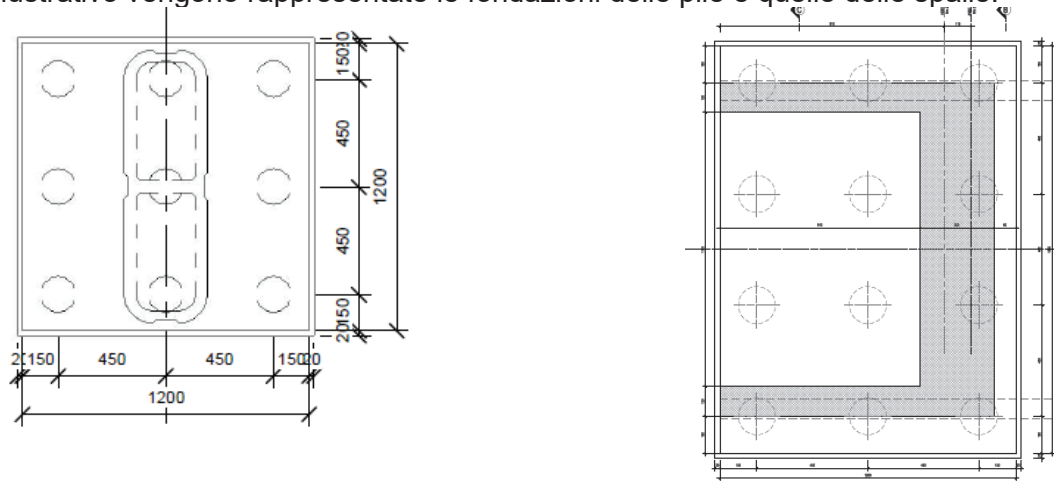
Pianta delle fondazioni delle pile e delle spalle
